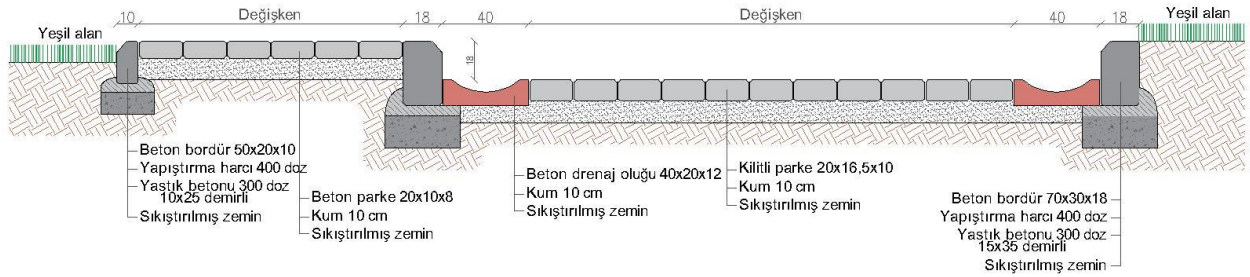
Proje alanındaki kilitli parke ve beton parke döşemeler (Çay,R.D. arşivi)
